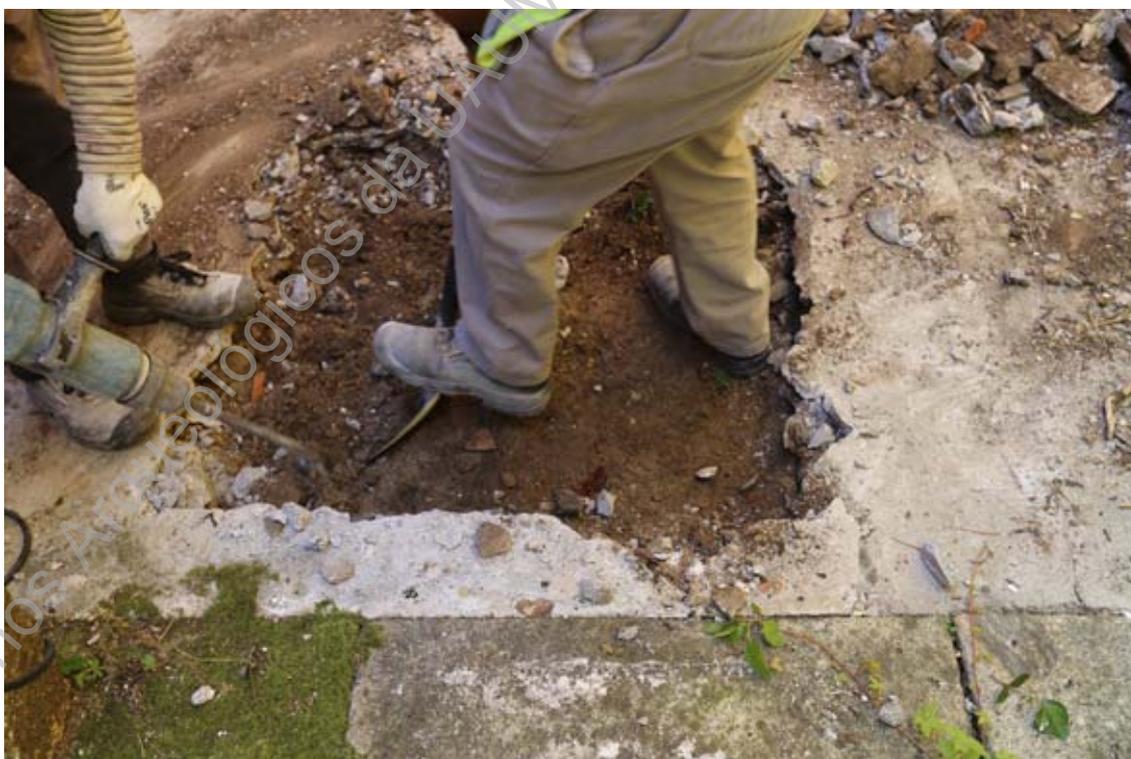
(IMG_8992) – Levantamento do pavimento em cimento (UE023) para a realização da sondagem geofísica 1.
